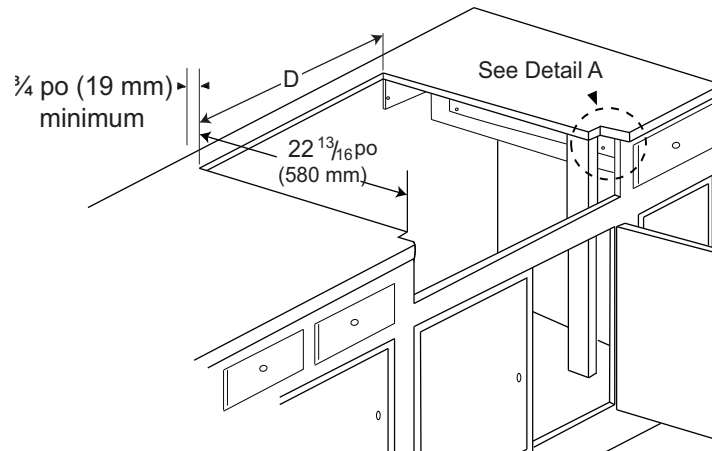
Installation en îlot (sans rebord de plan de travail)
